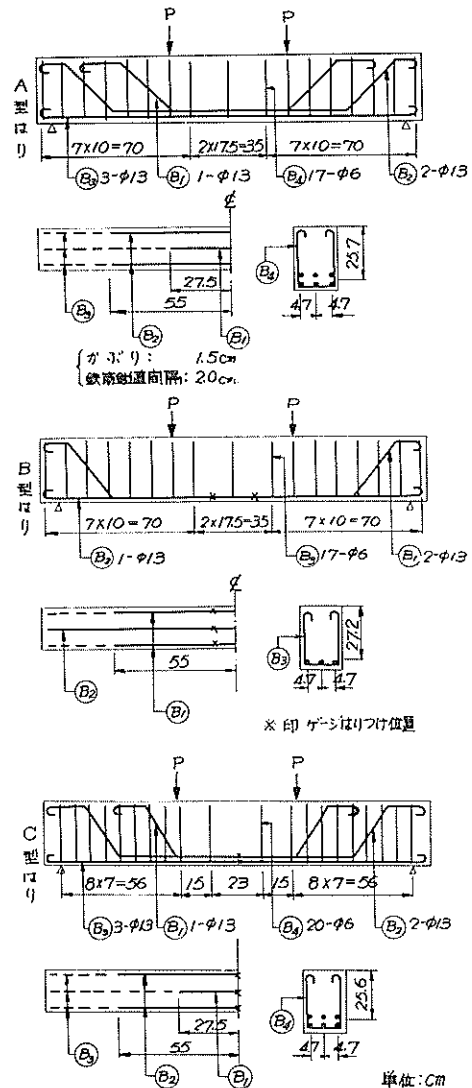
鉄筋コンクリートばりの形状および寸法と配筋図
